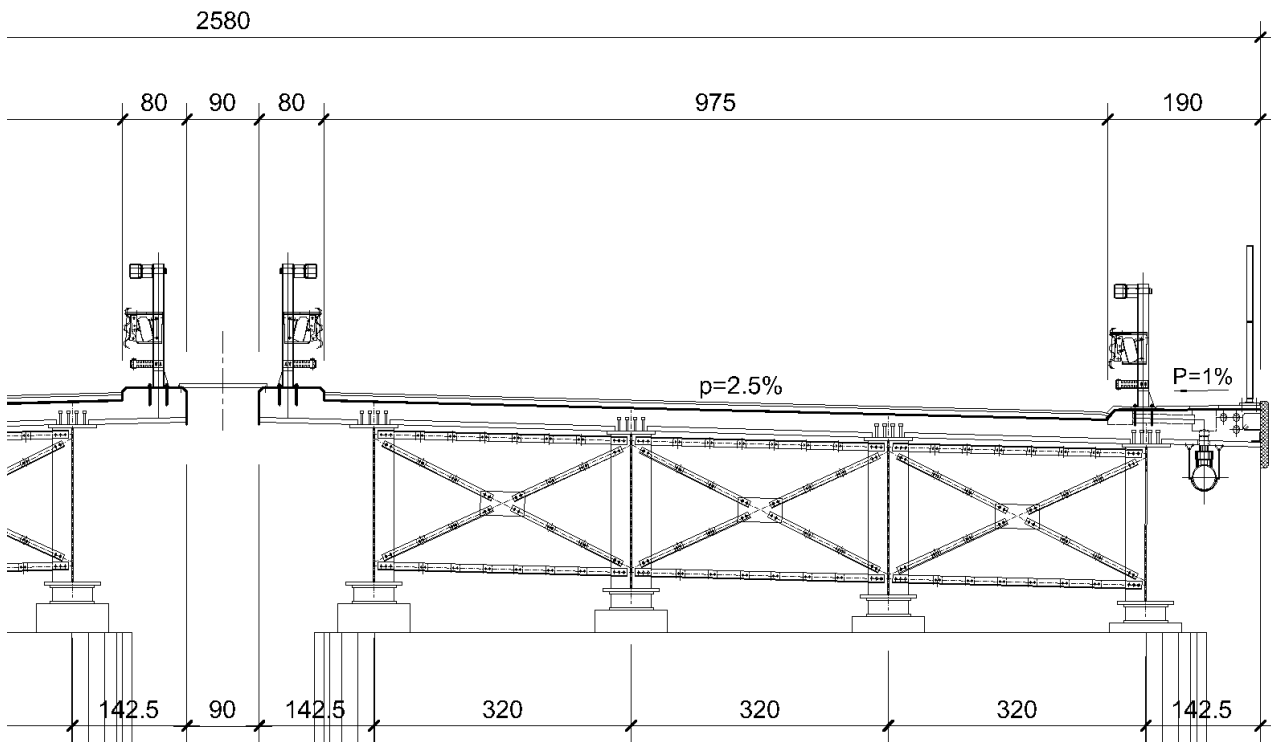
SEZIONE IMPALCATO (SU PILA)
